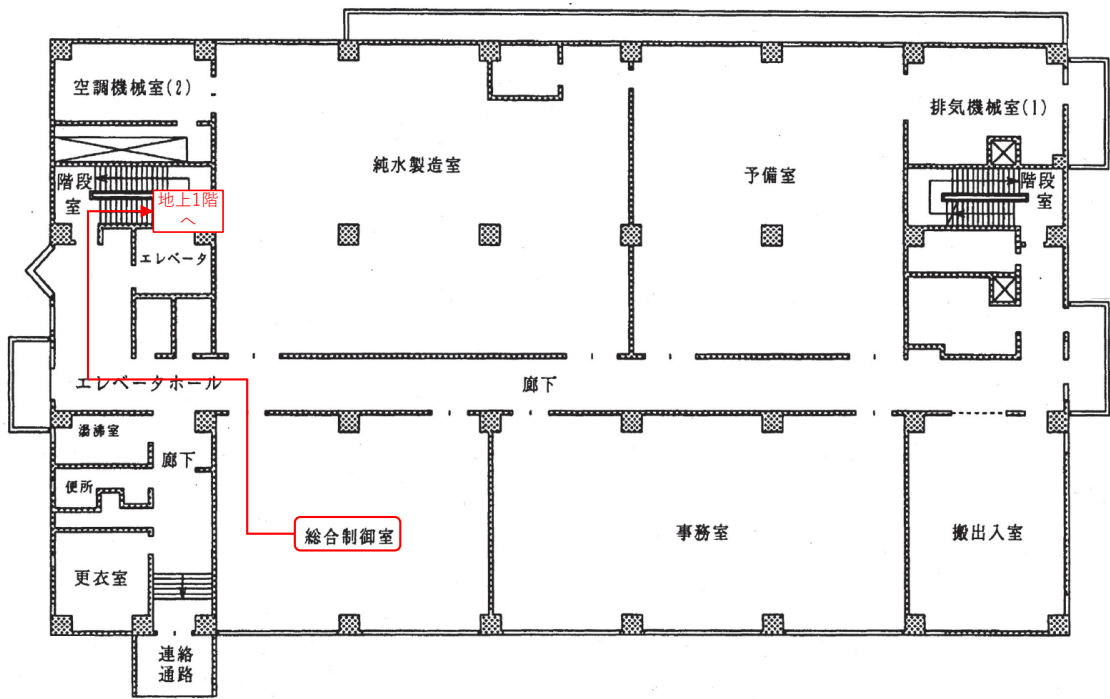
(1) 移動経路 (ユーティリティ施設 3F 平面図)
